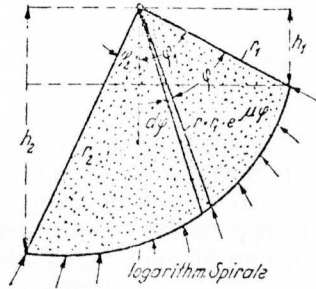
Bezeichnungen für spiralförmige Gleitflächen.
